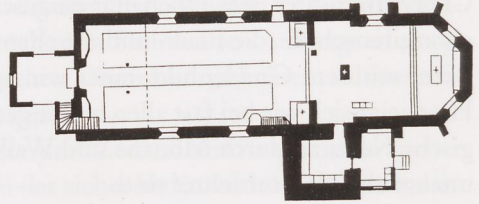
Haisterkirch, Pfarr- und Wallfahrtskirche
